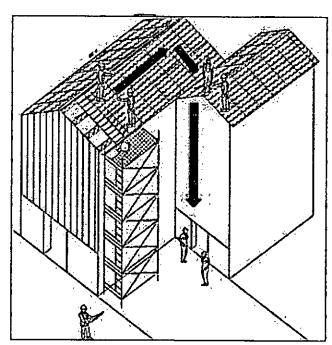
Instrucción de retiro de paneles de techo deteriorados.
